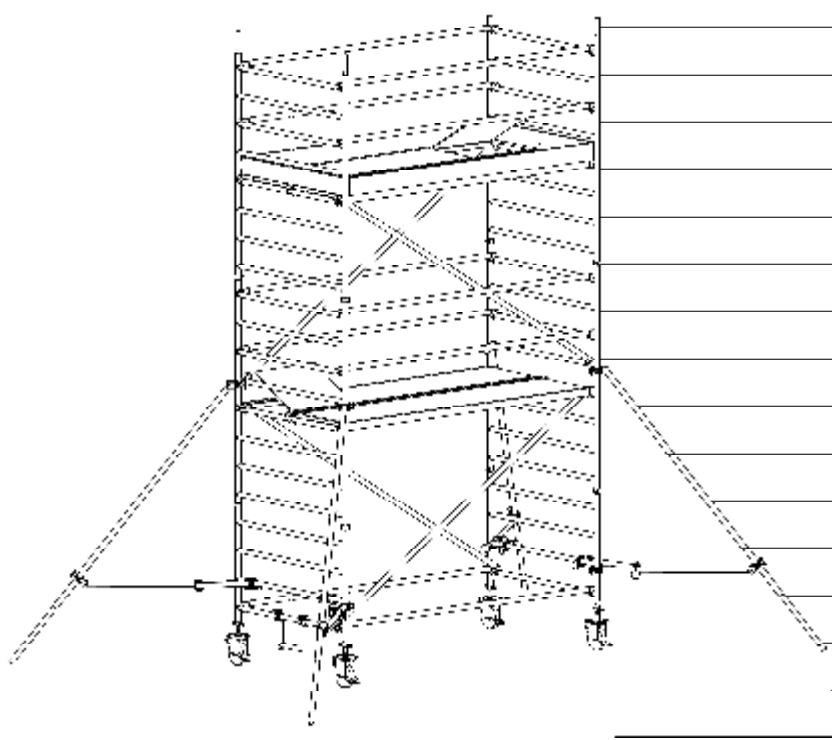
Aufbau mit Alu-Gerüststütze, Standhöhe 2.25 m
